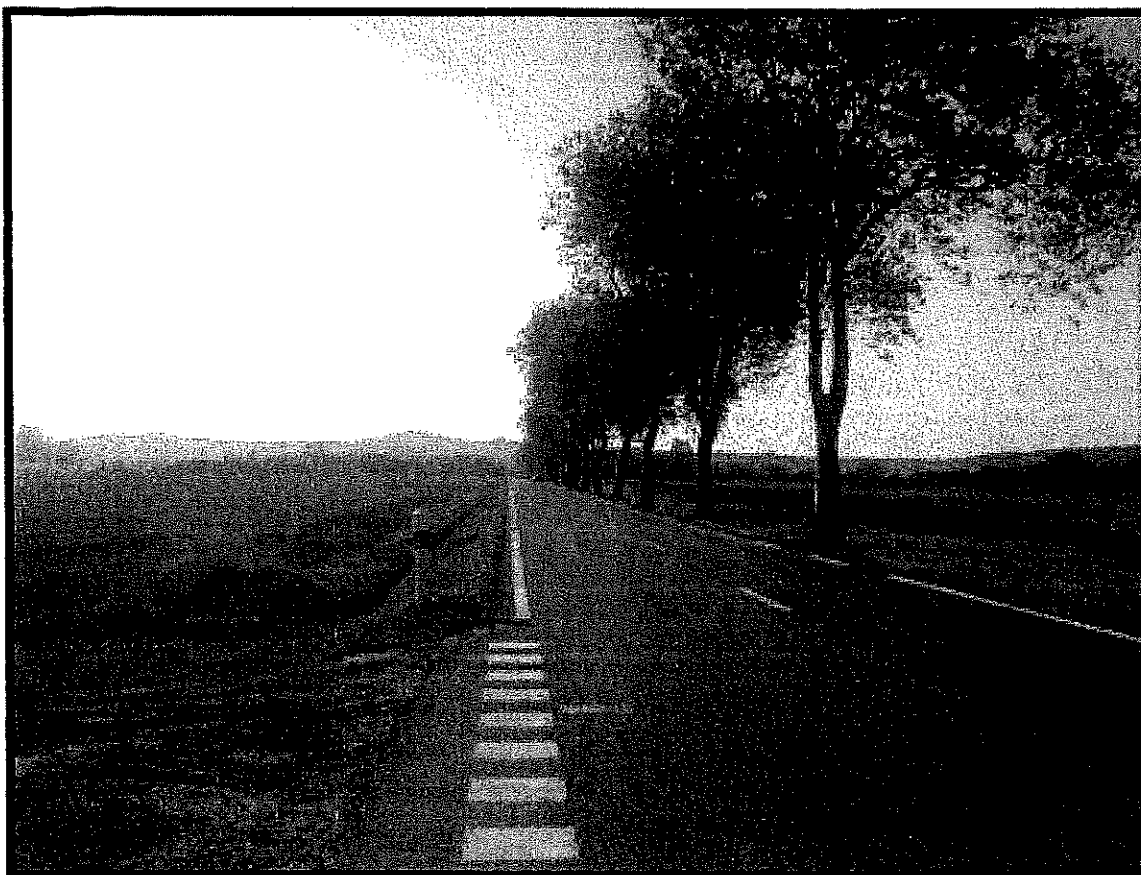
Vue depuis le carrefour d'"En Croix" vers le village
